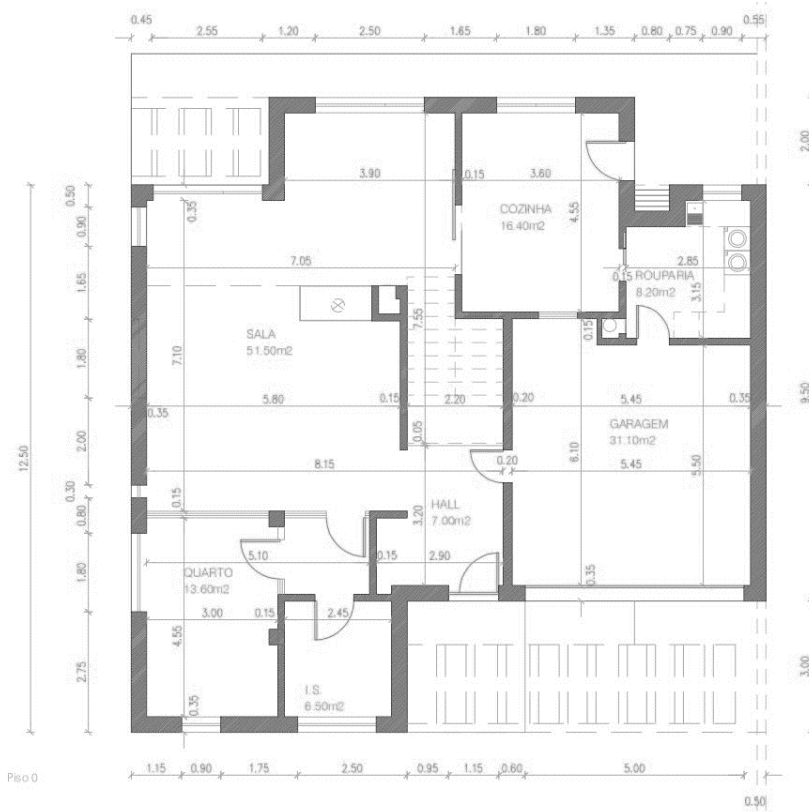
Planta Cotada, Piso 0 Raquel L.
